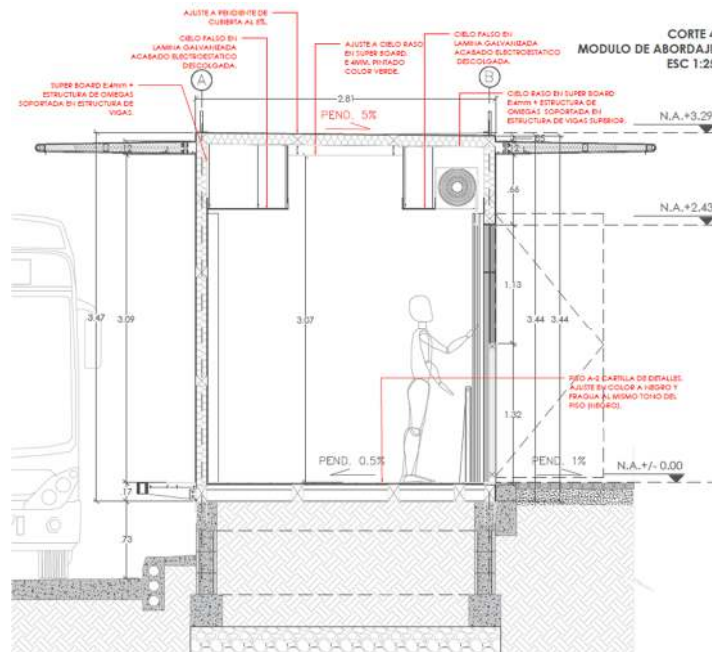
Corte transversal vagón abordaje. Plano 12. A-302 CORTE GENERAL 3 - 4.dwg
